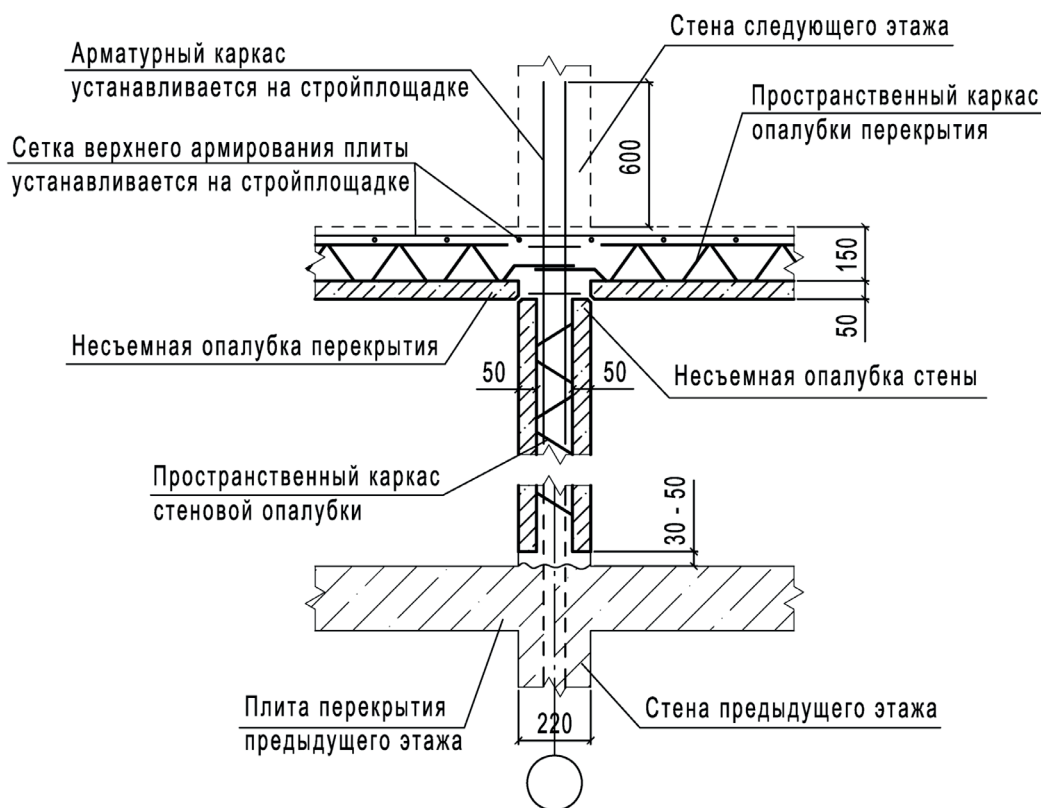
Соединение стен и перекрытий в несъемной железобетонной опалубке (толщины стен и перекрытий указаны справочно)
